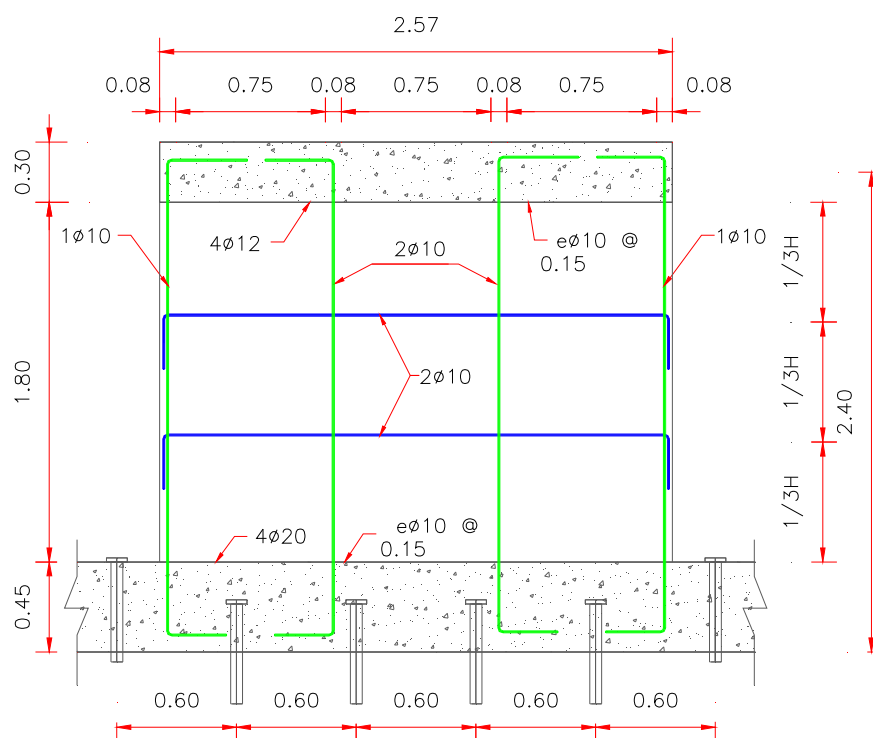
Geometría de los muros3.2.3 Construcción de la Pared con Trabado Horizontal
